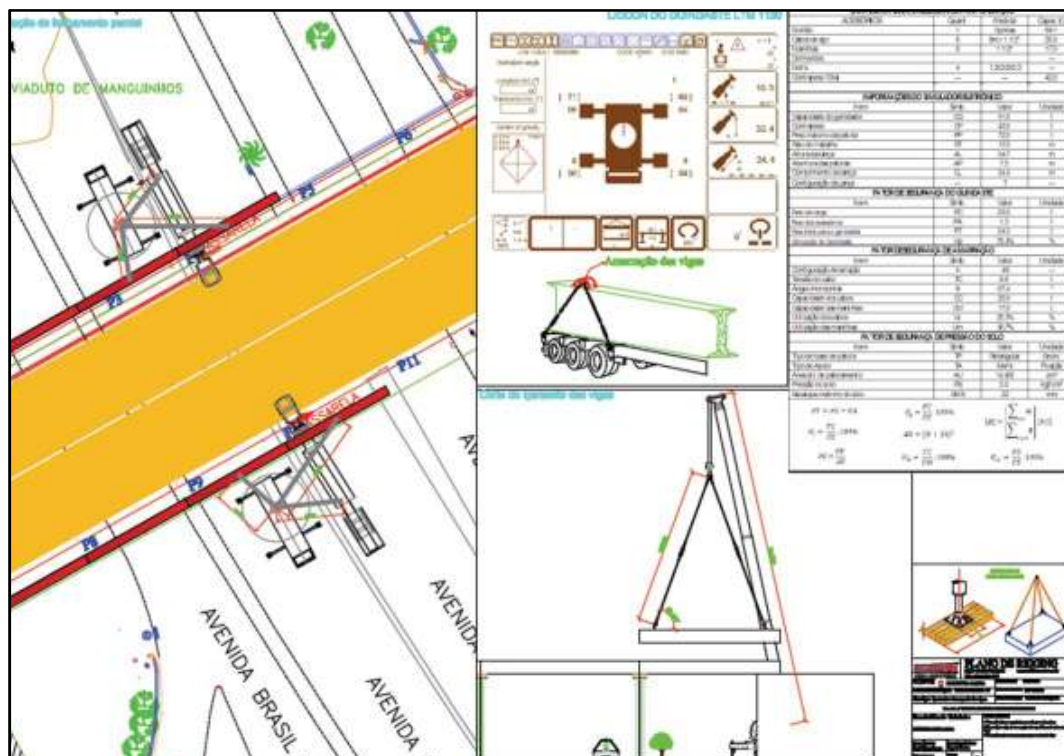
Projeto elaborado pela subempreiteira Transmacri constando o posicionamento e especificação do guindaste e as vigas possíveis de serem lançadas nesta mesma posição. Trecho posicionado sobre Av. Brasil, havendo necessidade de interrupção de uma faixa durante a execução do serviço.
